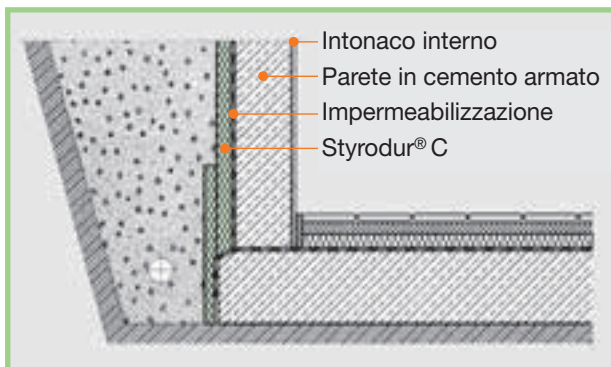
Posizione a terra dell'isolamento perimetrale. Il pannello di Styrodur® C appoggia sulle fondamenta.
